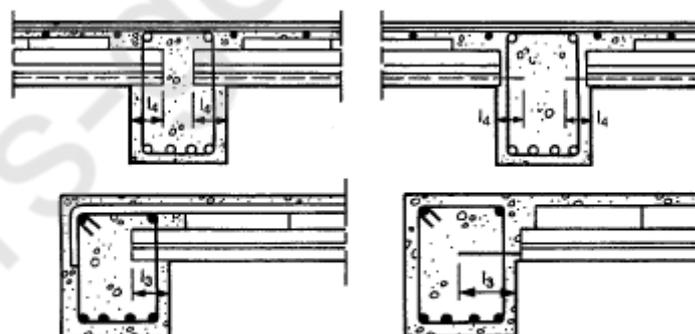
Liaisons d'appui pour planchers à prédalles
